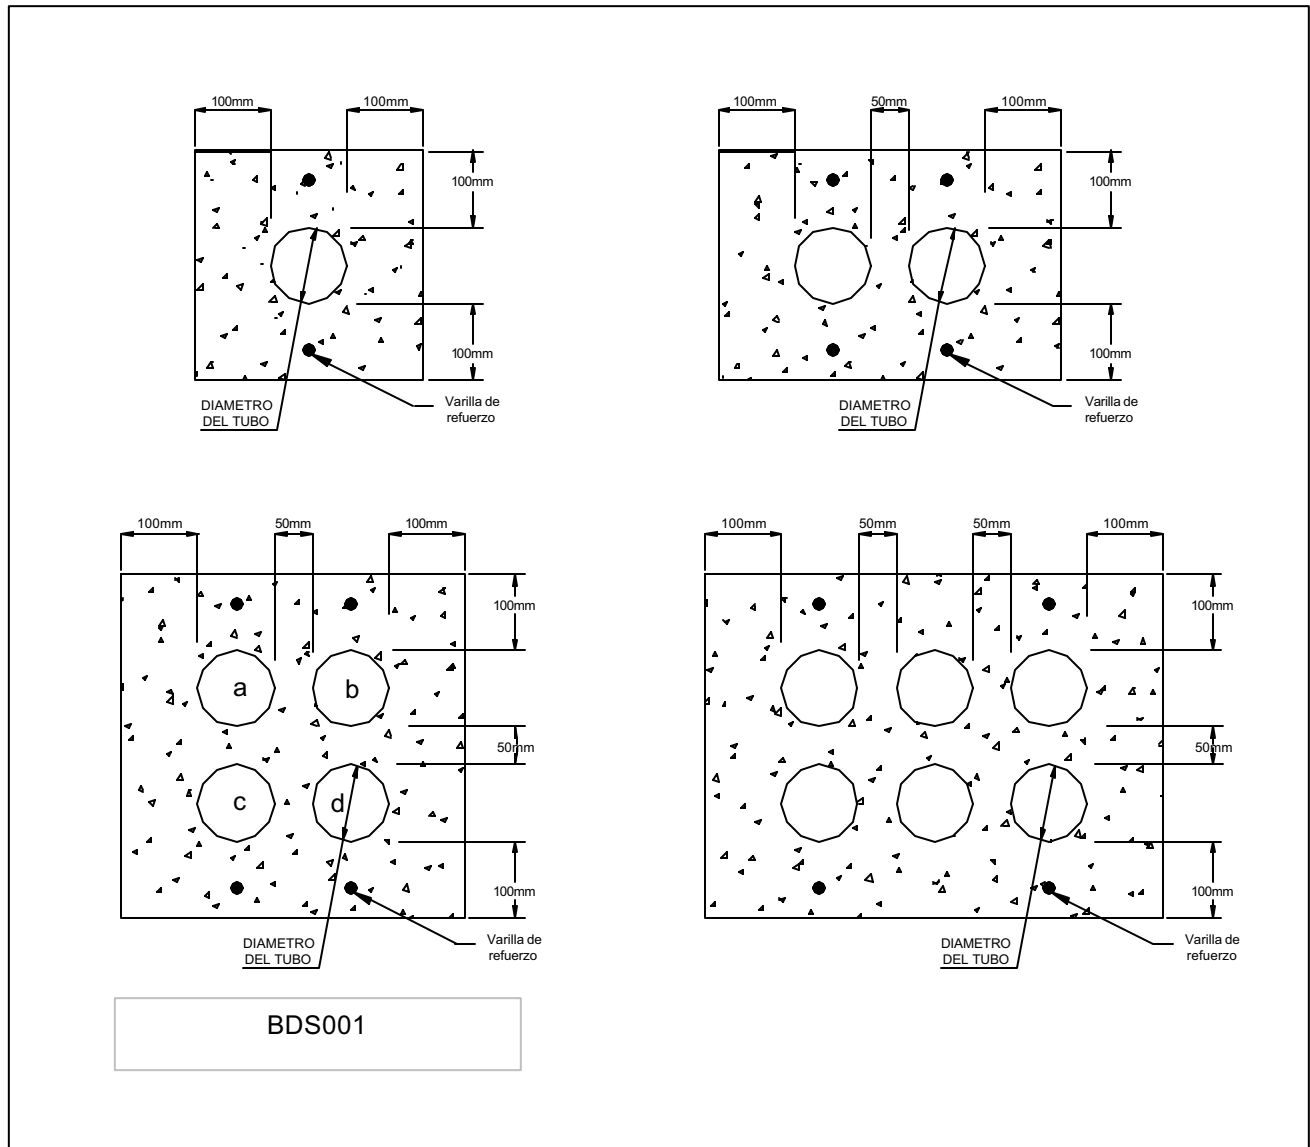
Banco de ductos subterráneos (Corte transversal).
